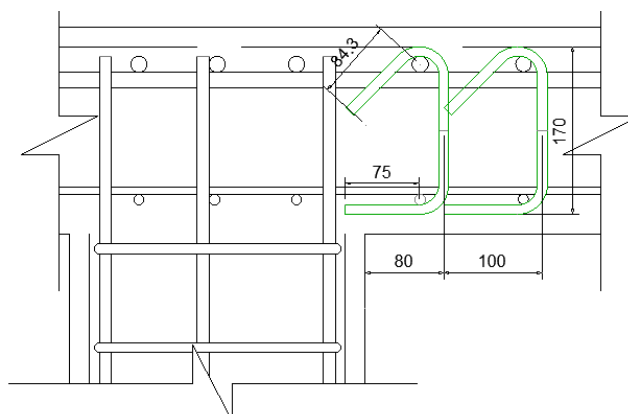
Detalhe dos estribos (Autora, 2023).
